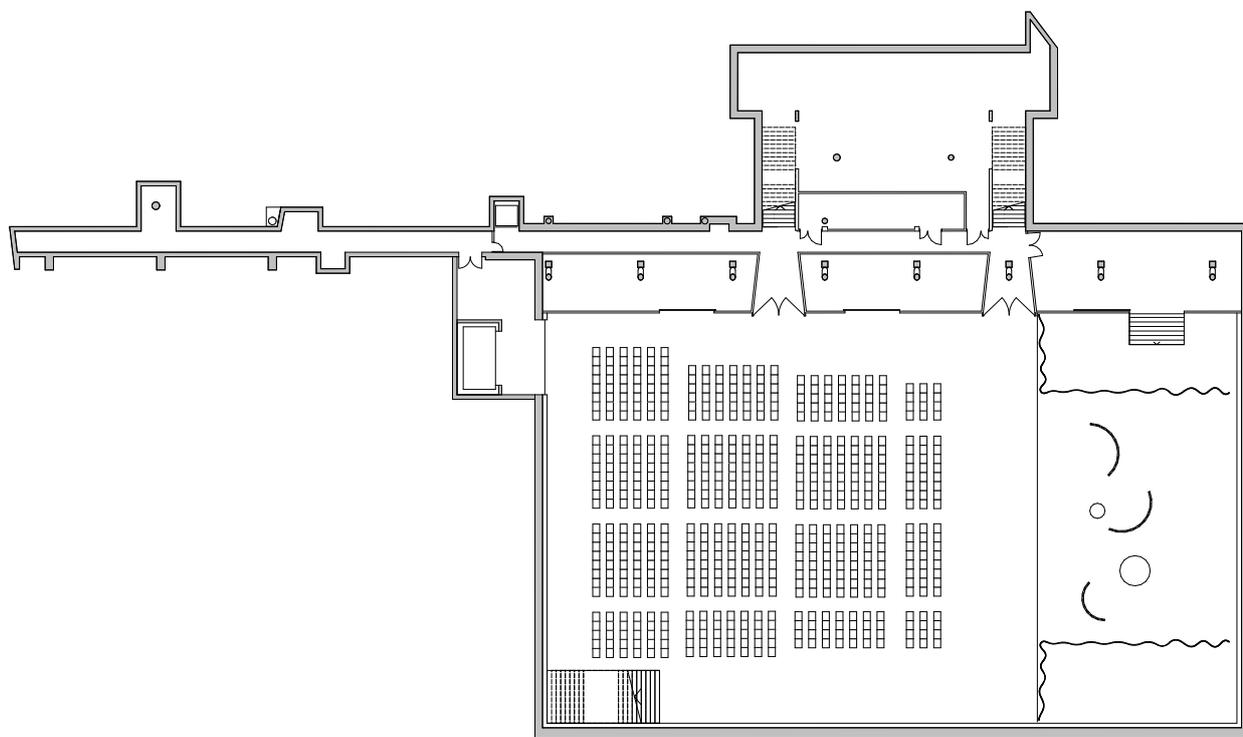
Grundriss 2.UG - große Veranstaltung
